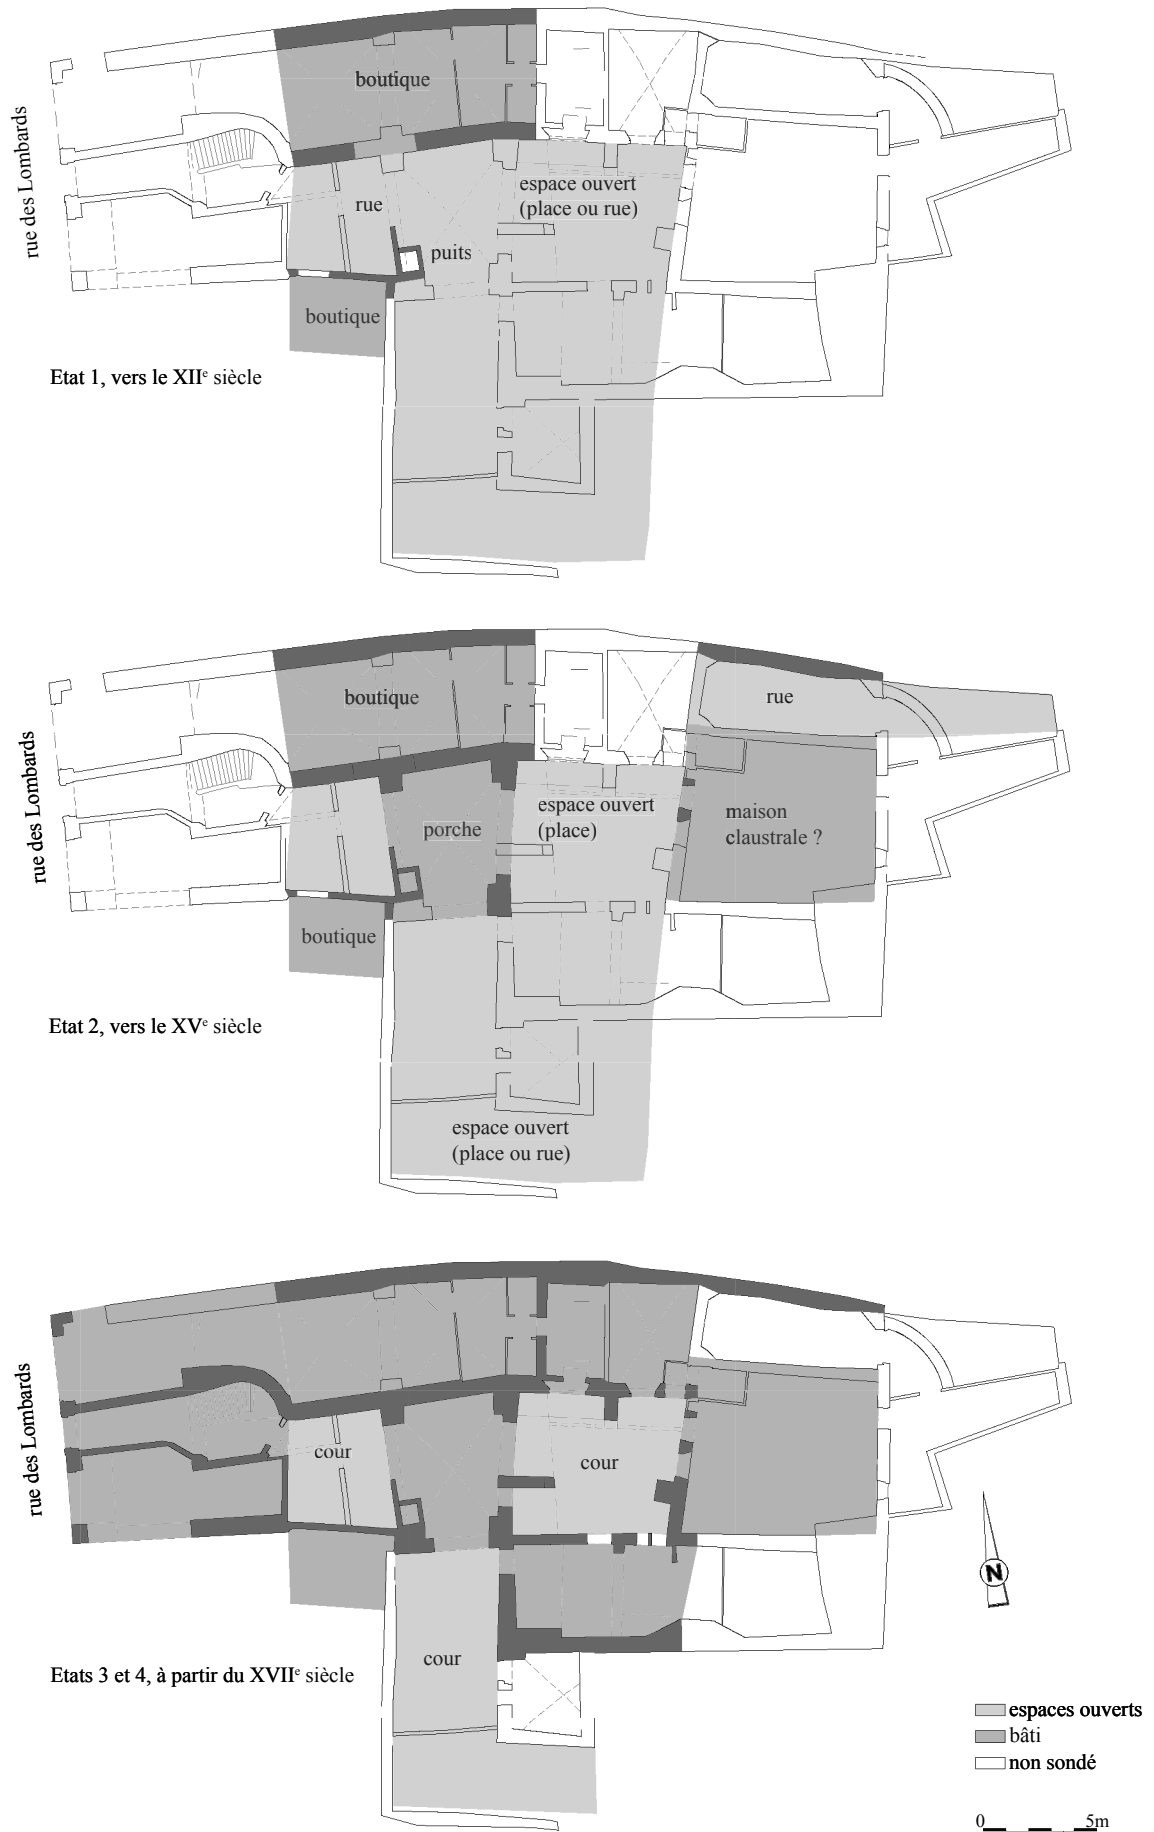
Plan phasé du rez-de-chaussée de l'immeuble (Plan N. d'Artigues architecte DPLG, infographie B. Thomas).
